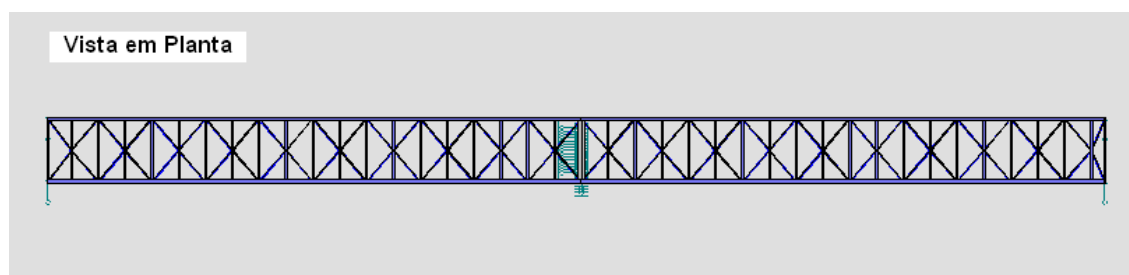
Vista em planta da Ponte Real modelada no ROBOT.
